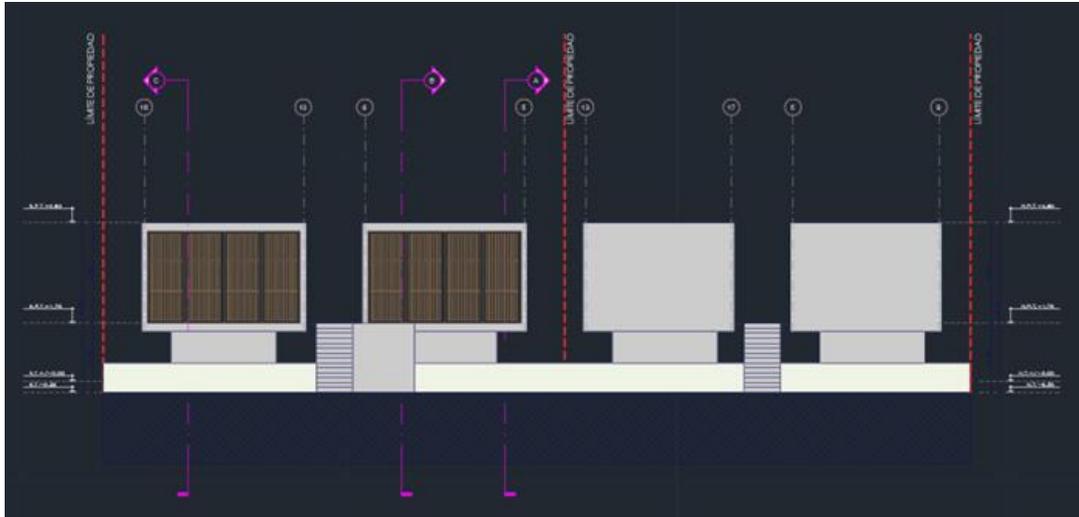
Alzado principal y Alzado posterior del proyecto concluido
